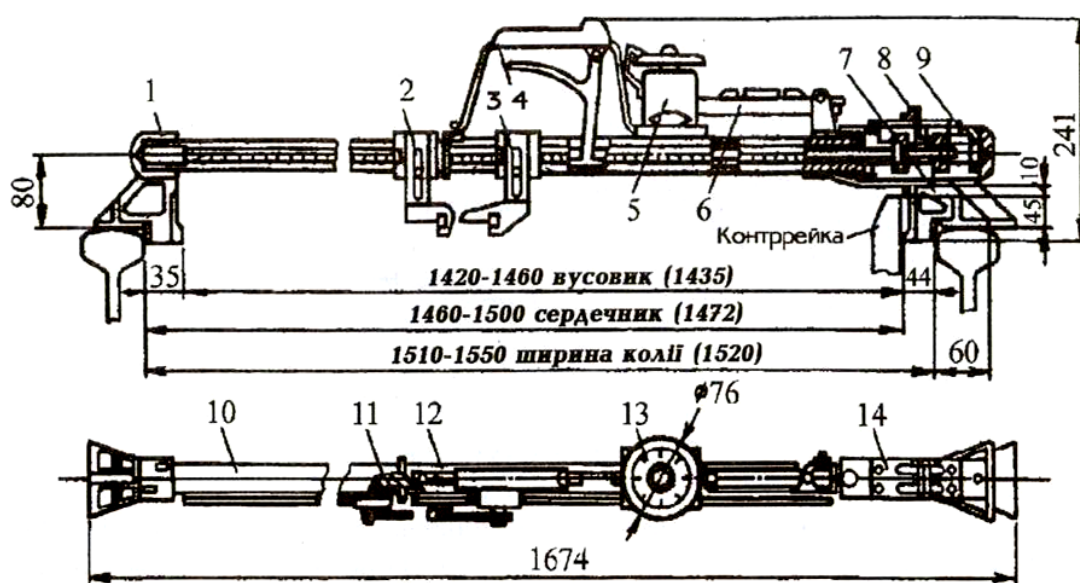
Контрольний шаблон ЦУП-3Д: 1 – нерухомий упор; 2, 3 – упори для вимірювання ординат перевідної кривої; 4 – ручка; 5 – корпус рівня; 6 – рівень; 7 – рухомий упор; 8 – покажчик шкали ширини колії; 9 – направляюча; 10 – ліва частина корпусу шаблону; 11 – ізоляційна бобіна; 12 – права частина корпусу шаблону; 13 – шкала рівня; 14 – шкала шаблону ширини колії.
